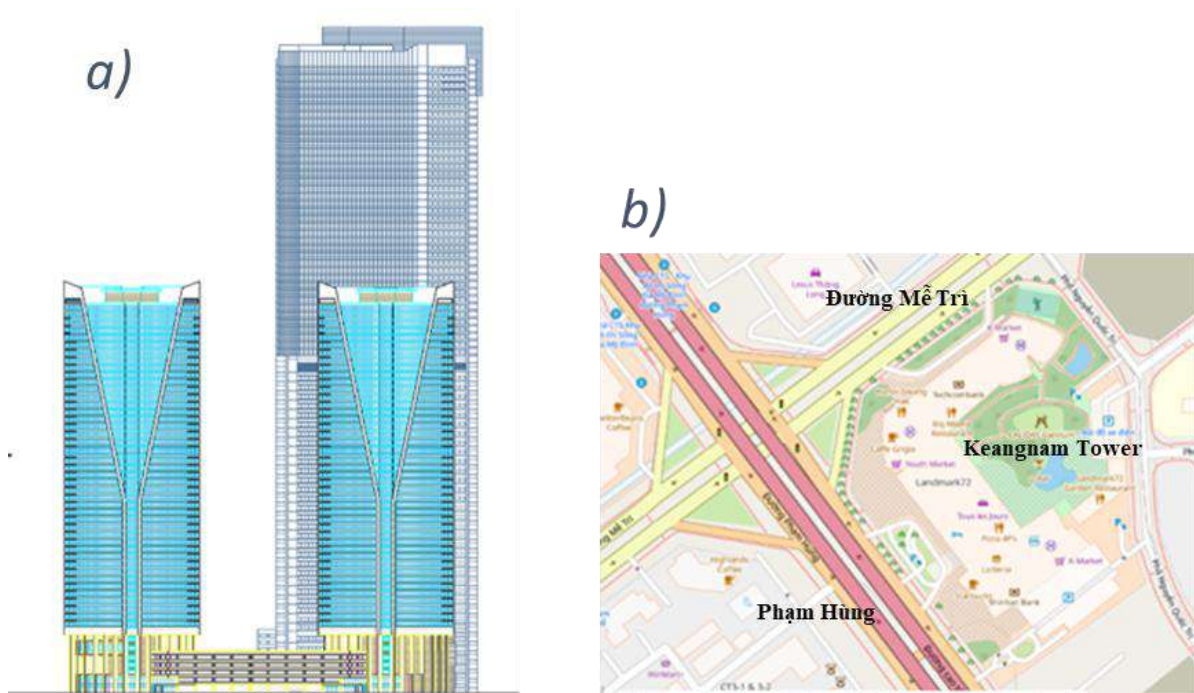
a) Plan architectural AutoCAD de la Keangnam Tower b) Extrait OpenStreetMap montrant les environs de la Keangnam Tower
